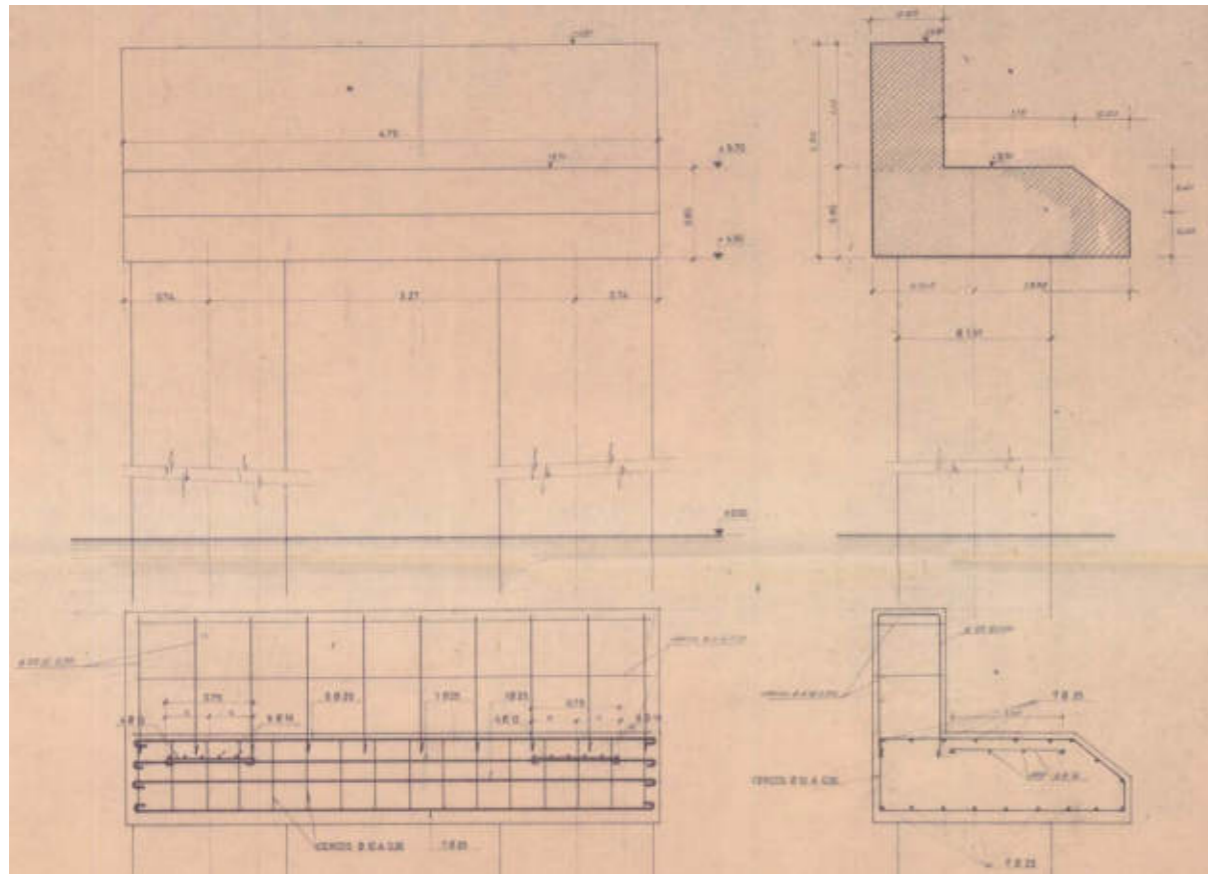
Cabecero tipo II - transición entre tramo 1 y tramo 2
